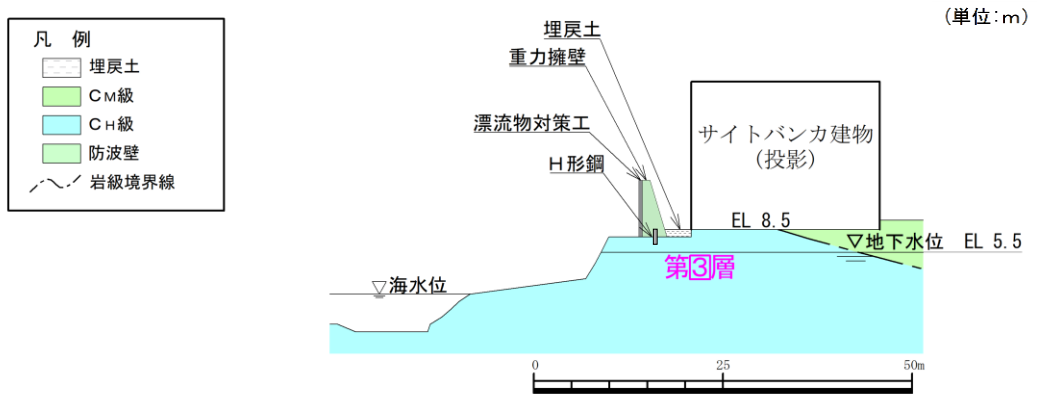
地質断面図 (⑤-⑤断面)
